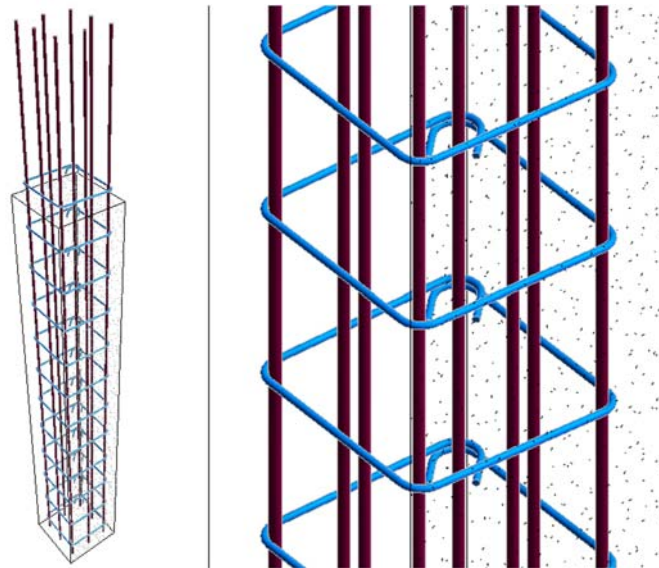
Модель розміщення арматури в тілі залізобетонної колони
